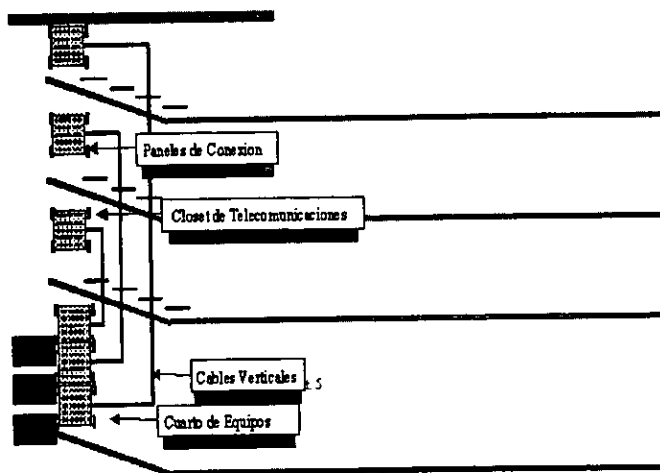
Diagrama de un cableado estructurado vertical.
